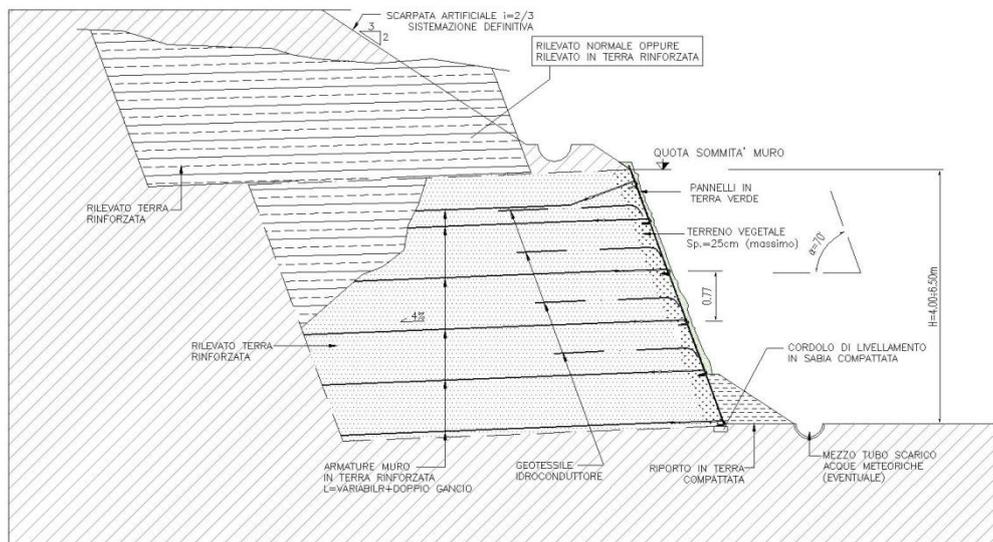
Muro in terra rinforzata. Sezione tipo
